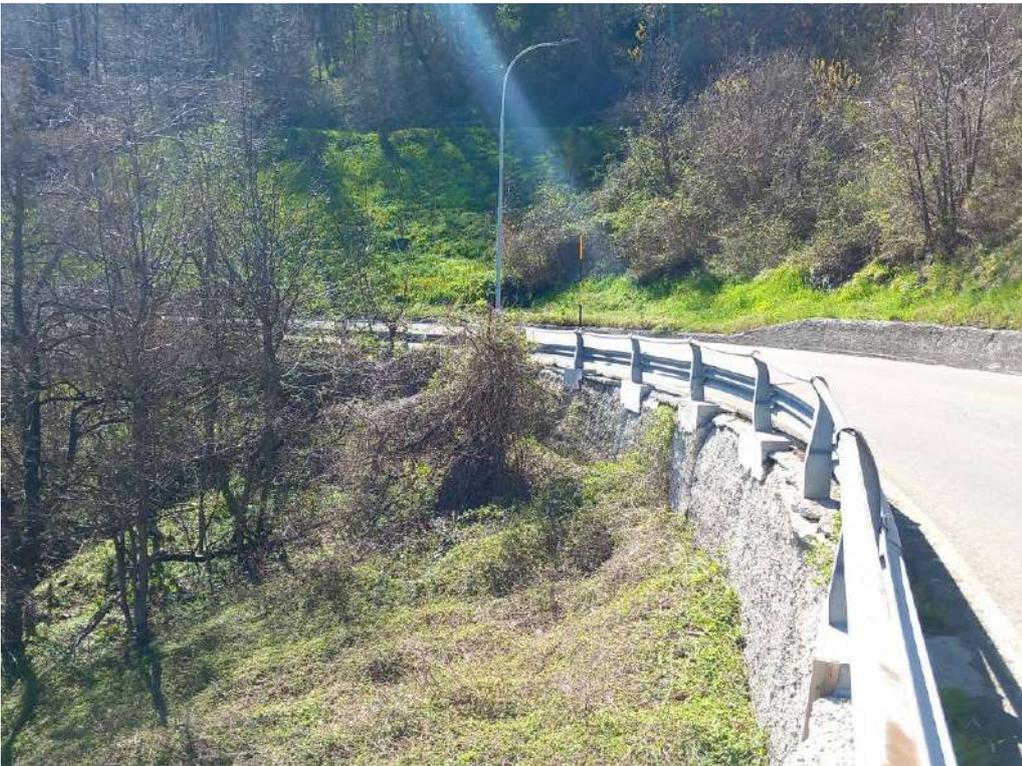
vista della barriera stradale su muro C, del degrado del muro e del cordolo sommitale, dei pali di pubblica illuminazione
